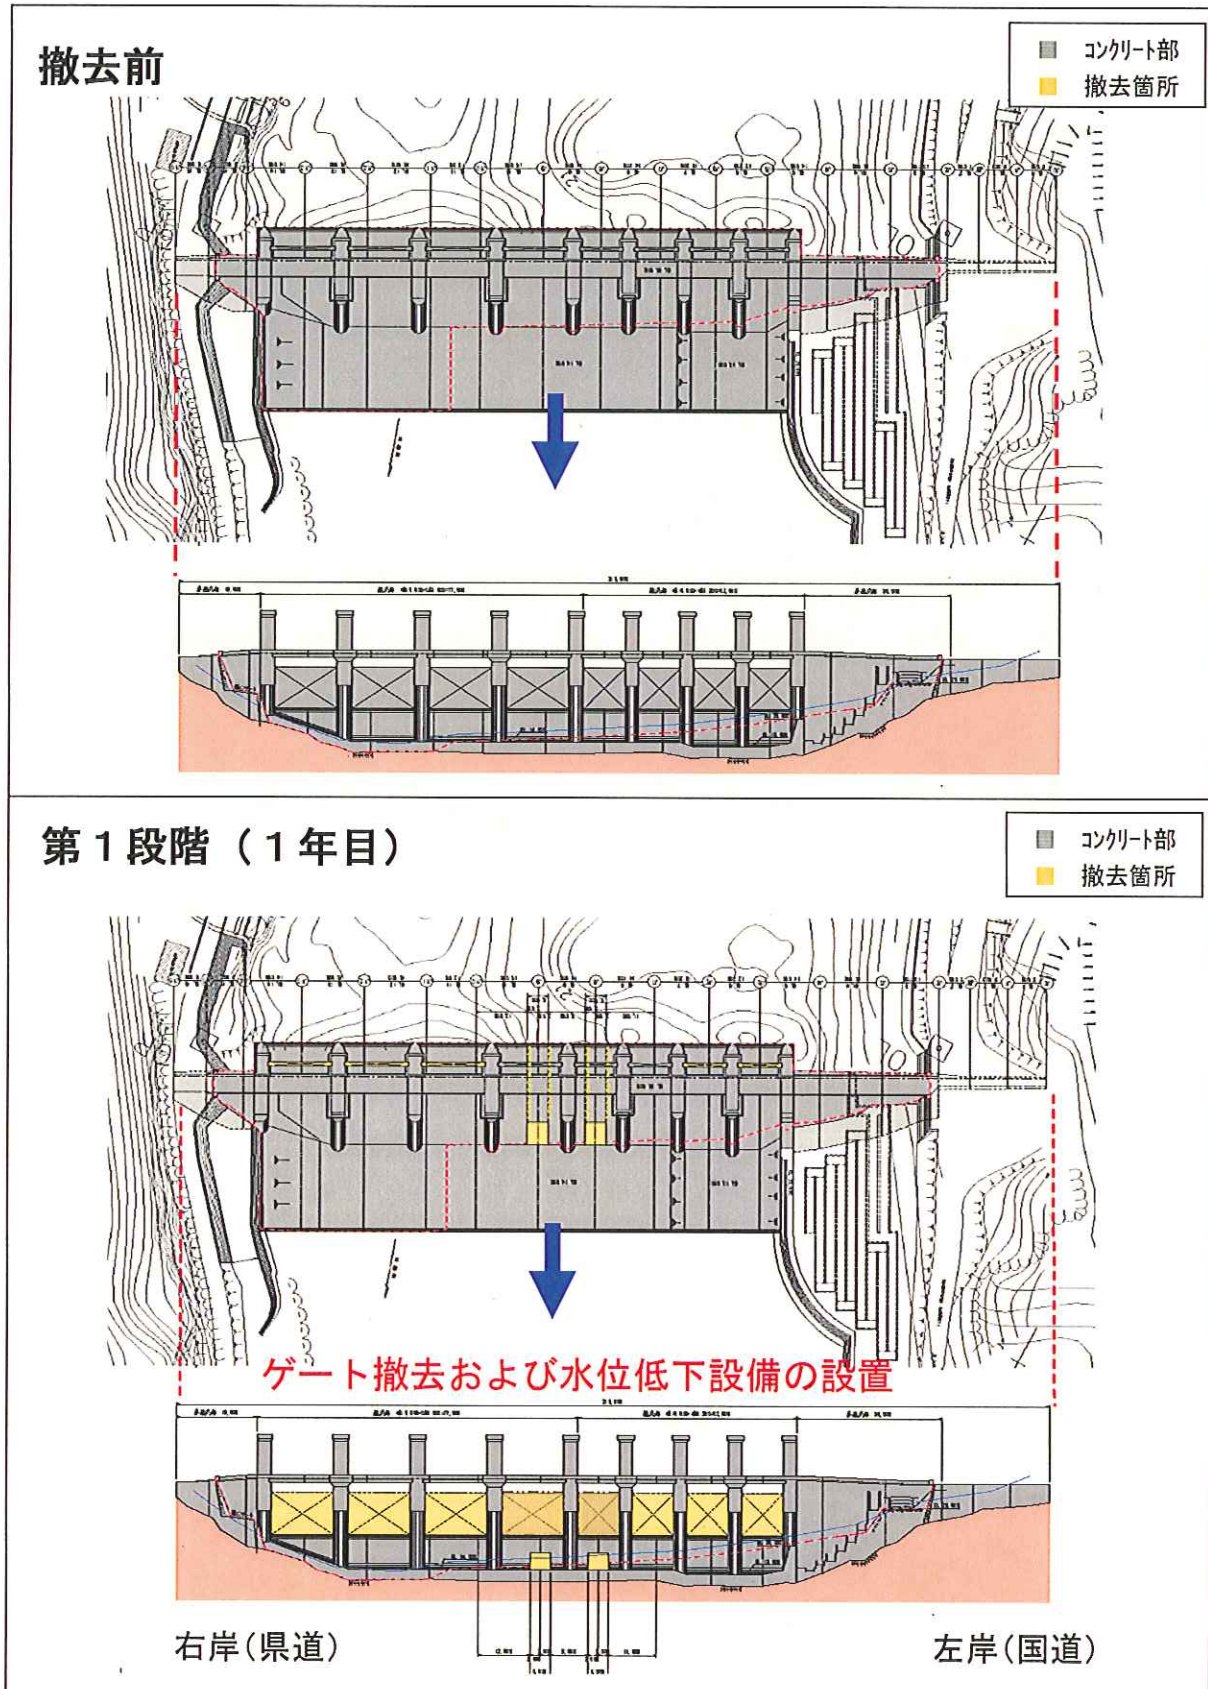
(1) 撤去計画平面図、下流面図 (撤去前、第 1 段階)
